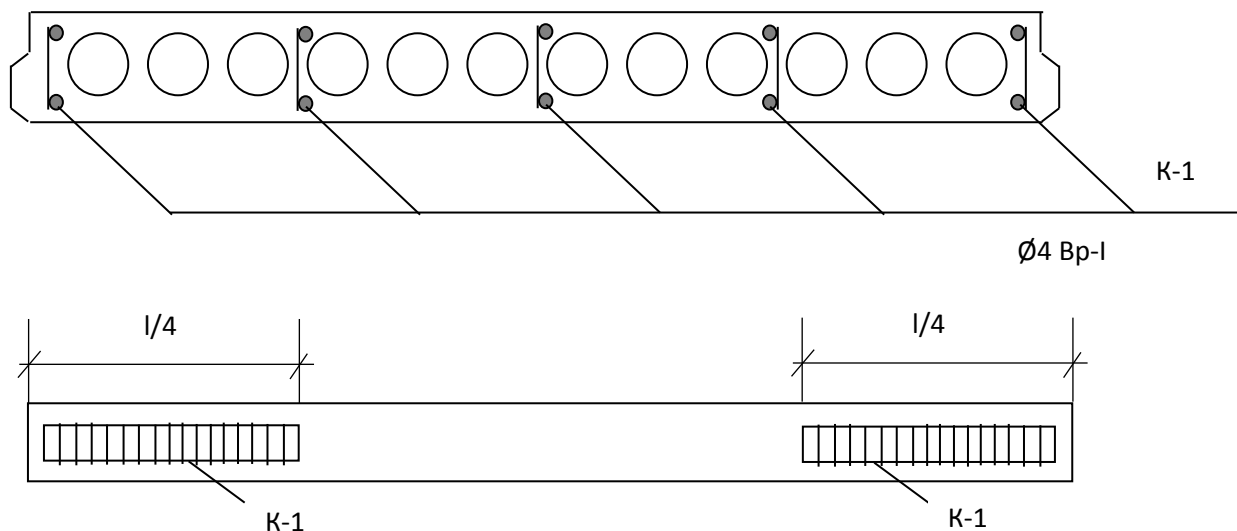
Размещение поперечной конструктивной арматуры в поперечном и продольном сечениях плиты (K-1 – сварные каркасы)
